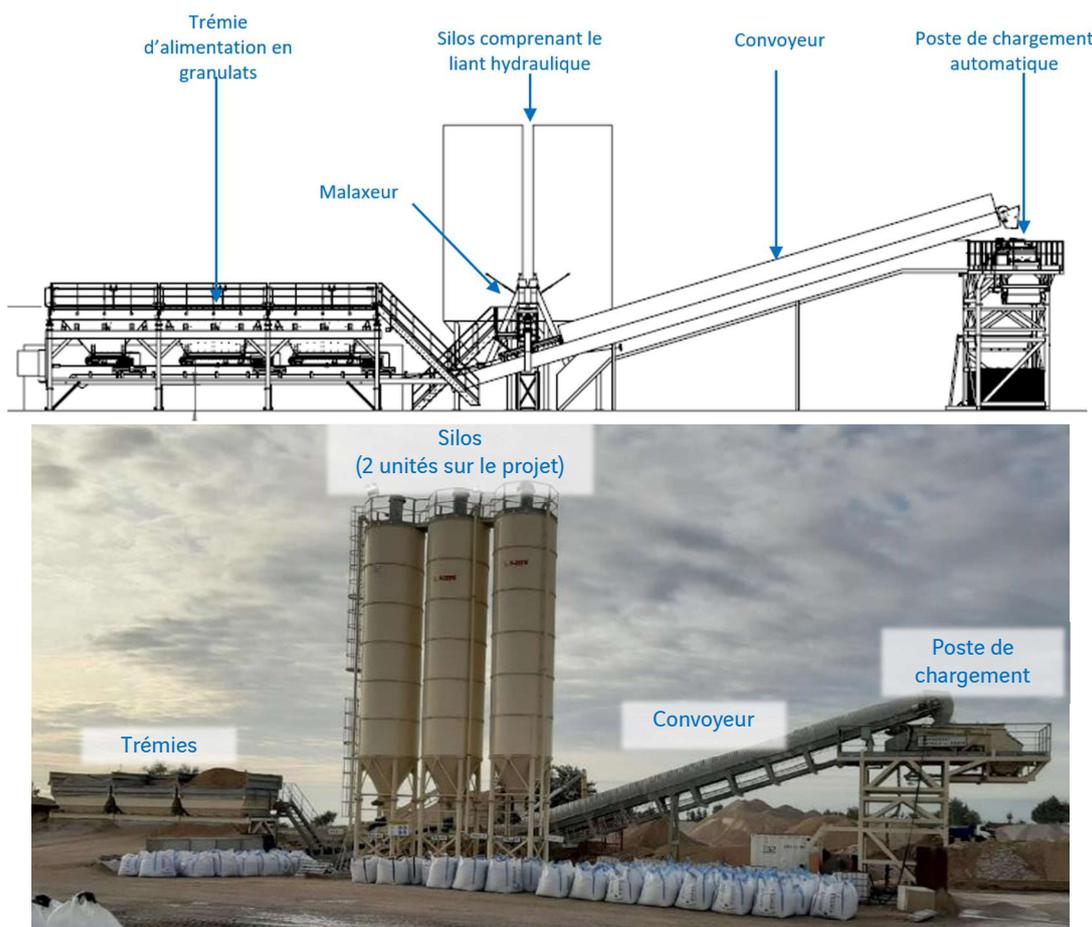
PLAN ET PHOTOGRAPHIE DE LA CENTRALE A BETON
